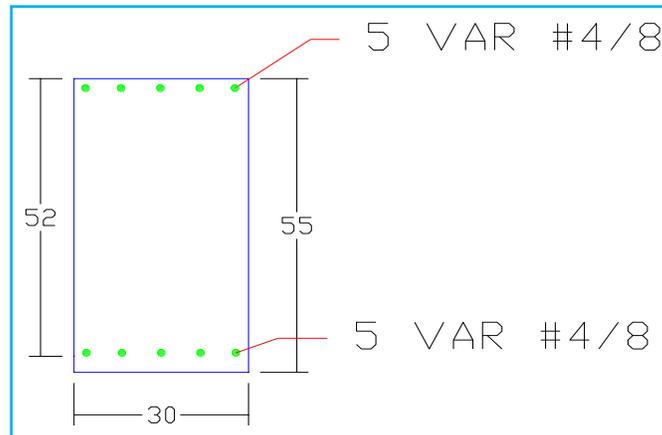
área de acero calculada para los últimos 2.4 metros de la viga a partir del apoyo empotrado.
